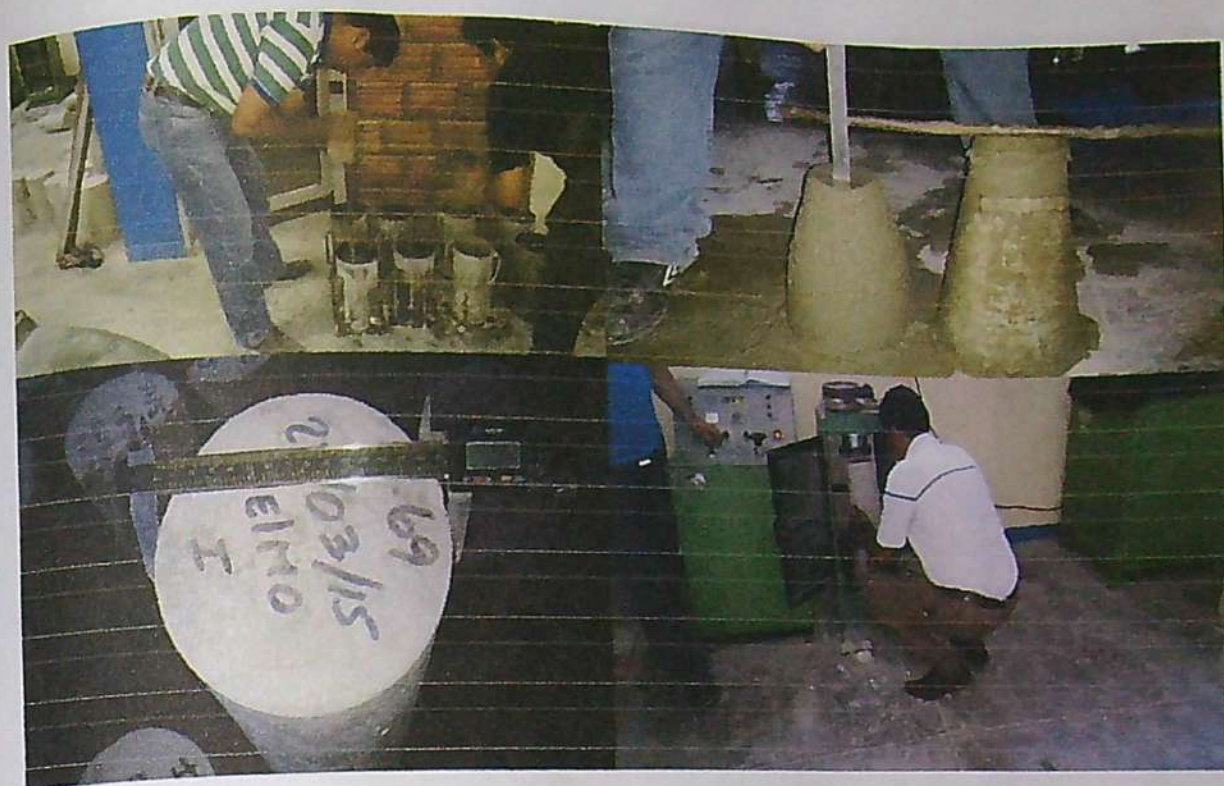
Determinación del Slump, prueba de resistencia a la compresión.
